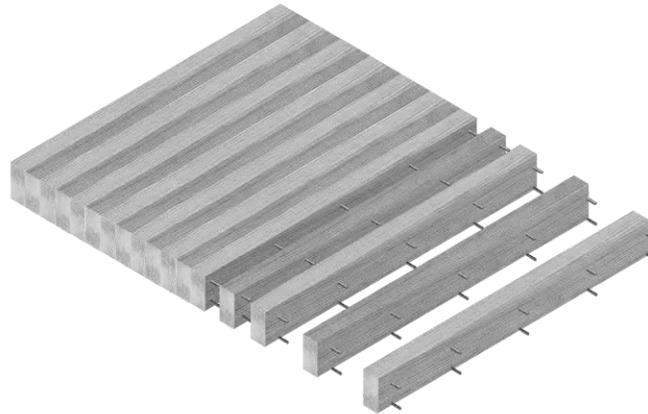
Nail-Laminated Timber (NLT). (ThinkWood & WoodWorks, 2021).
